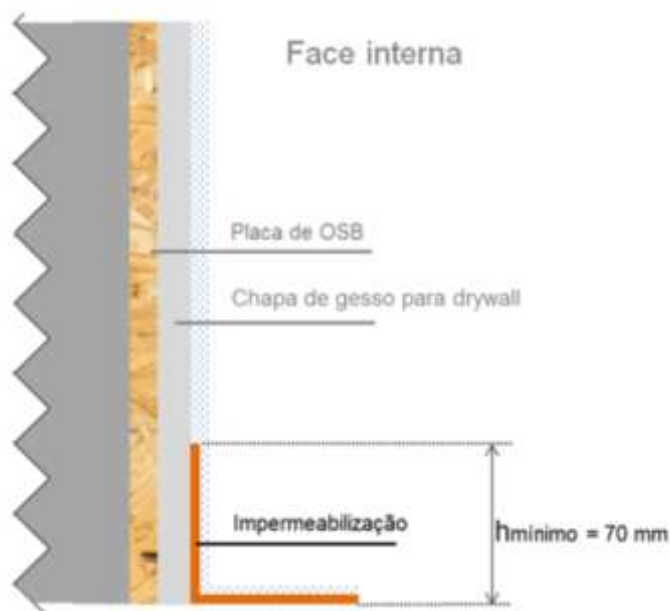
Corte esquemático de um Sistema de Vedação Vertical Externo para ilustração da impermeabilização na área do box
